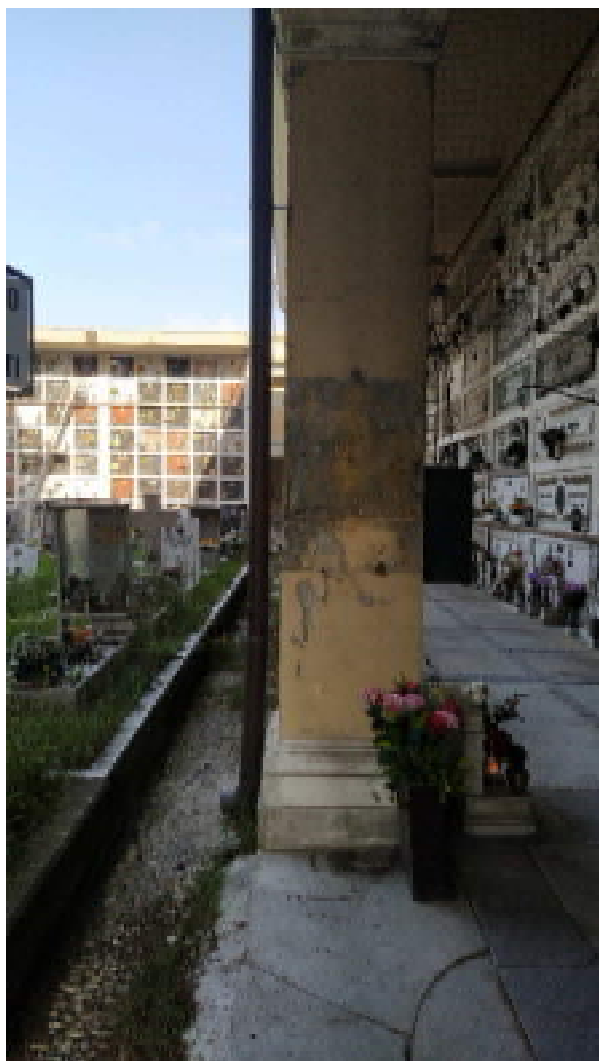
e 35: Vista porticato dal centro verso Nord Ovest e verso Sud Est
